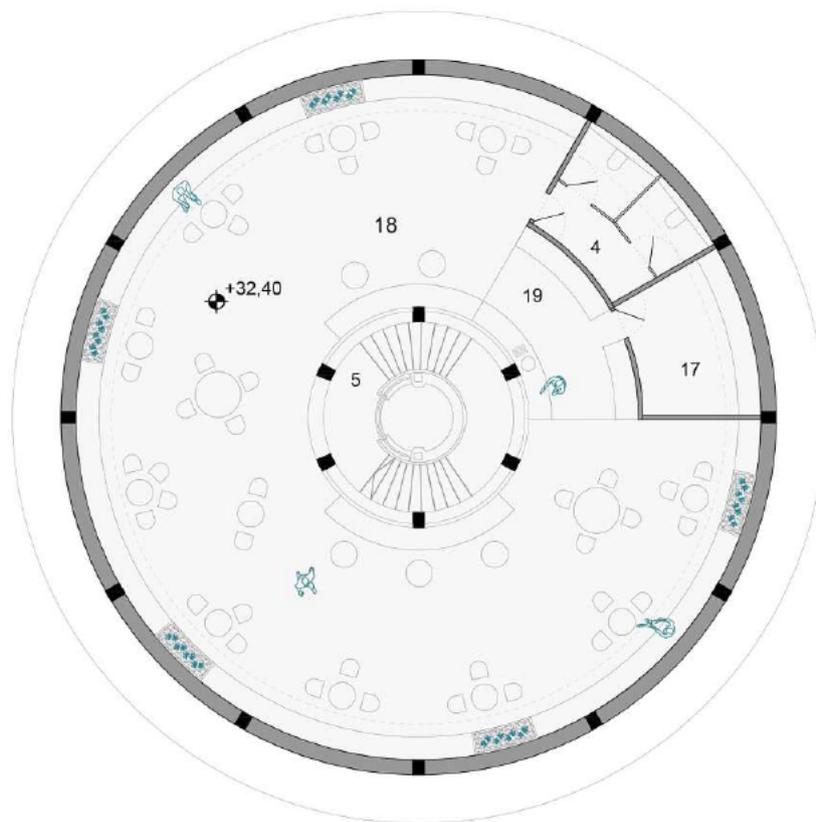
Grundriss 6.Obergeschoss
